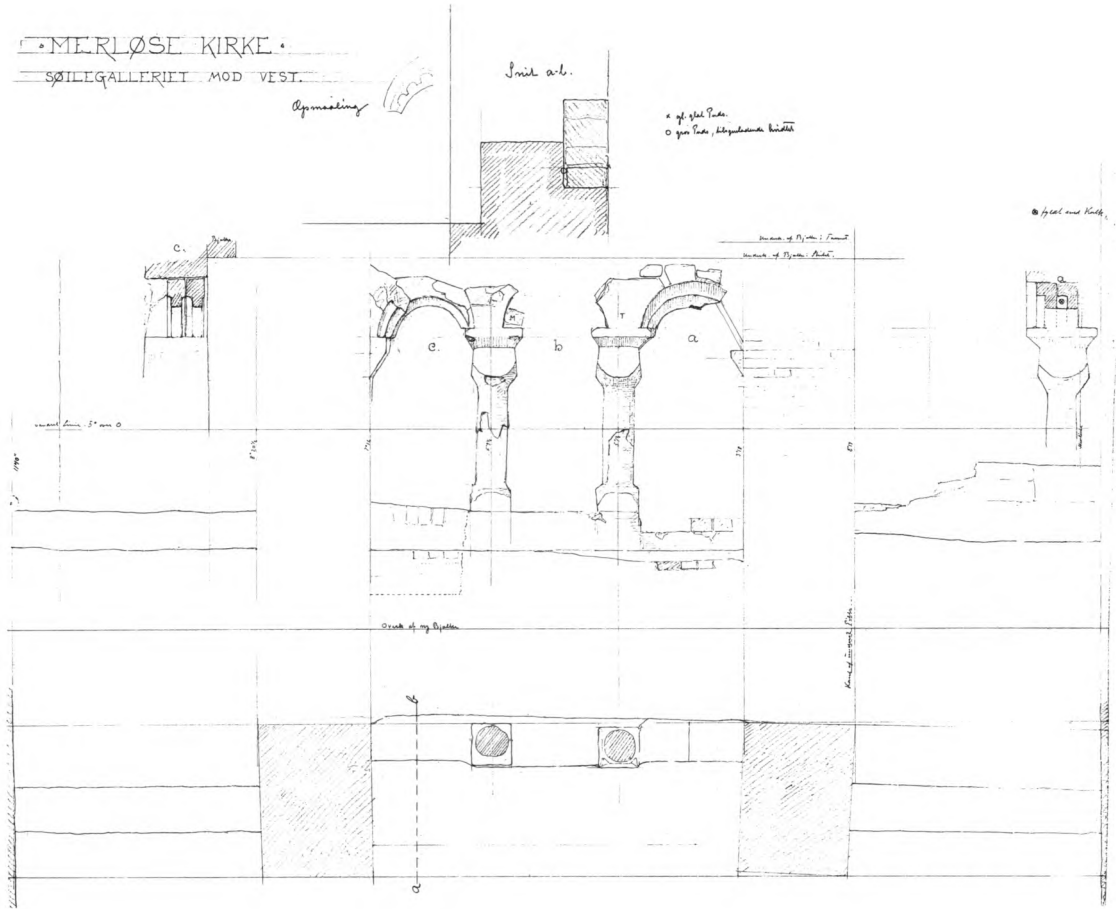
Detaljer af galleriet. 1:50. Opstalt, snit og plan (s. 2965). Måleblad ved Harald Harpøth 1893. - *Details of the gallery. Elevation, section and plan.
